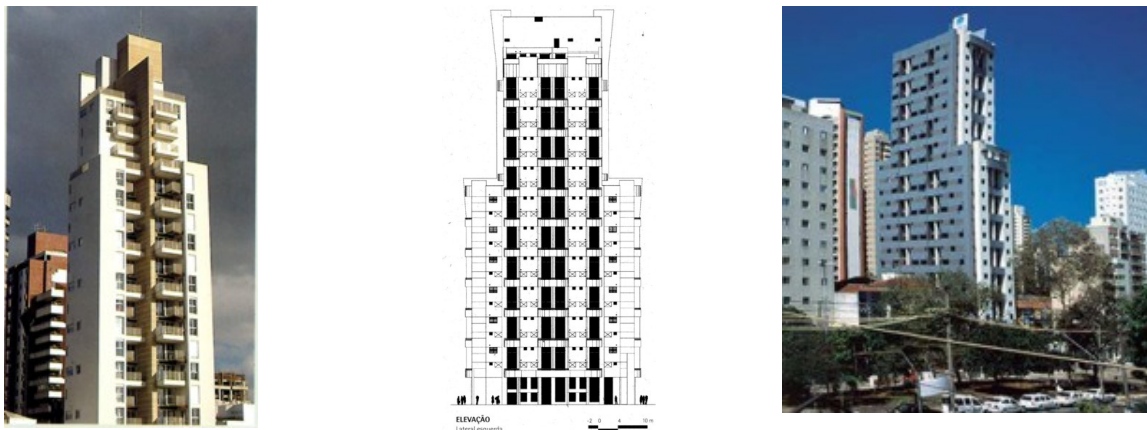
Foto do Living Loft (VA-07). Fachada do Duplex Top Tower (VA-08). Foto do Helbor Loft (VA-09).
